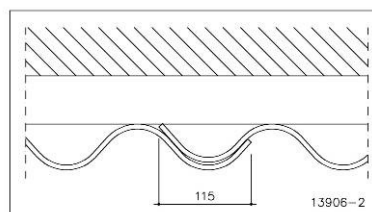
Recouvrement transversal – profil ECOLOR EXTRA
